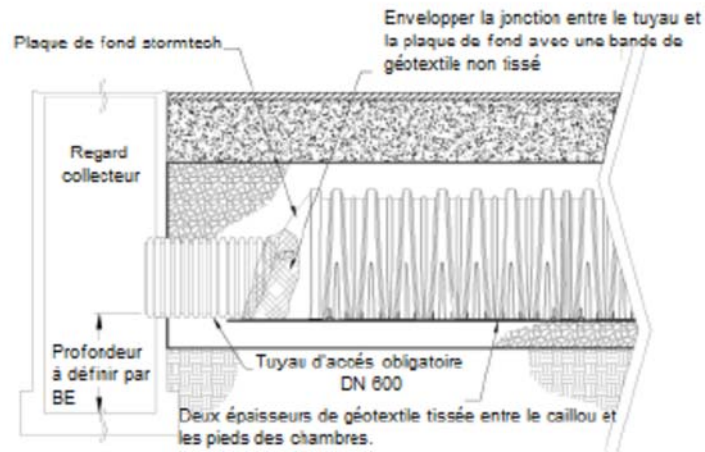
Plan de détail du dispositif de rangée d'isolation
